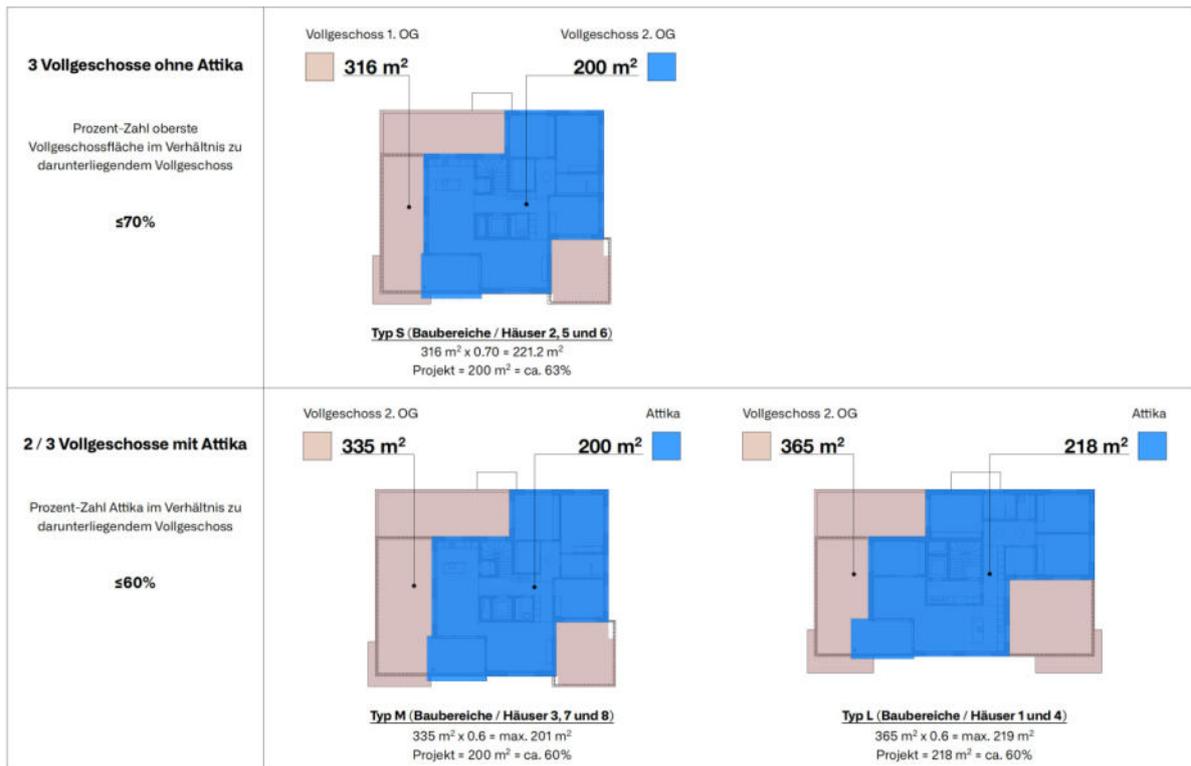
Vollgeschosse mit 70% und Attikageschosse mit 60%
